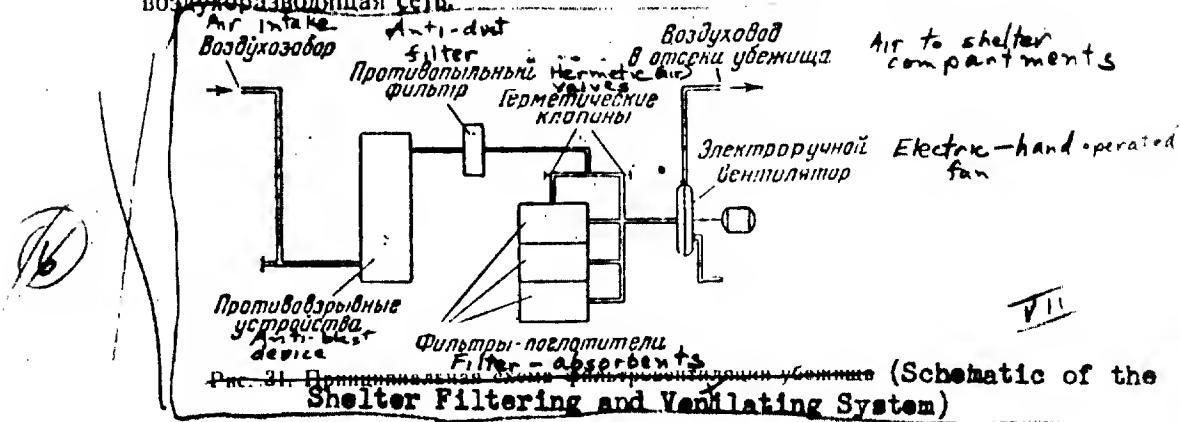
Принципиальная схема фильтровентиляции убежища (Schematic of the Shelter Filtering and Ventilating System)
